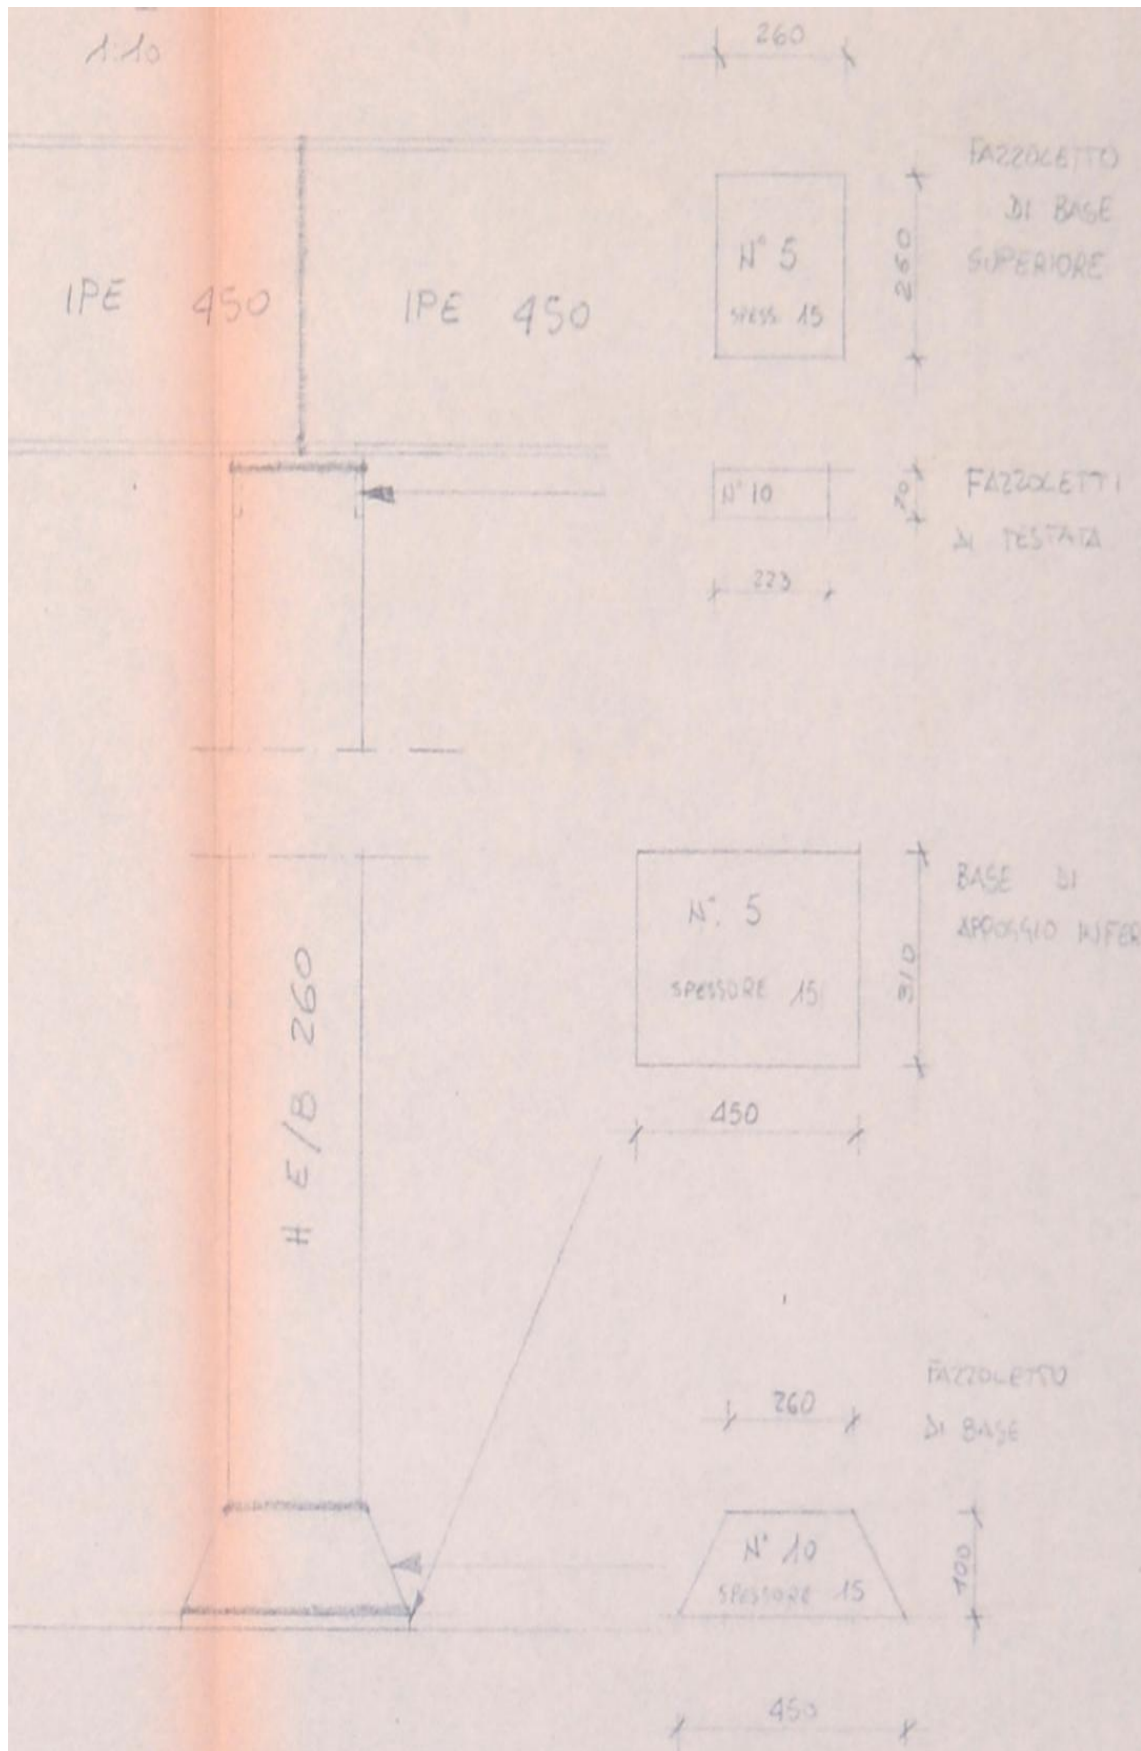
Particolare di A.1990.a.sa.T01 - Struttura in acciaio - Unione appoggio centrale travi principali
